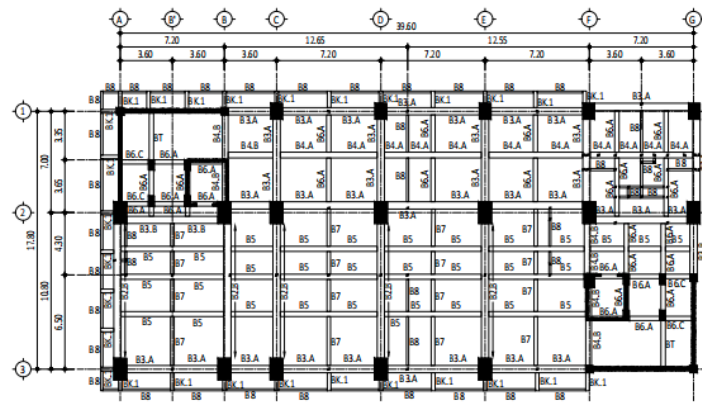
Denah Plat dan Balok Lantai 6
